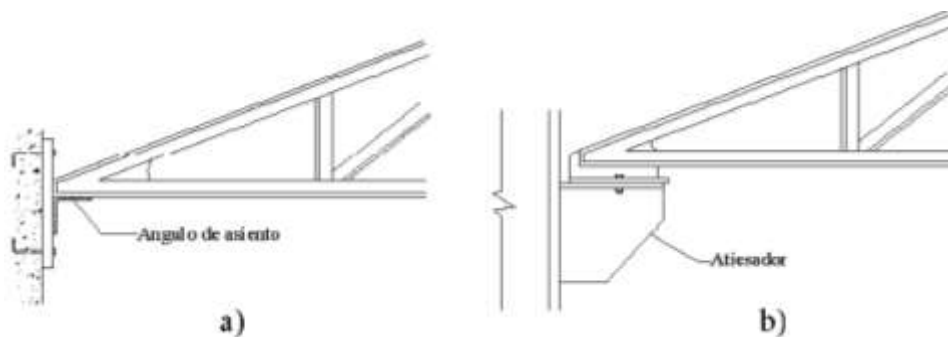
a) Apoyo atiesado; b) Apoyo no atiesado
